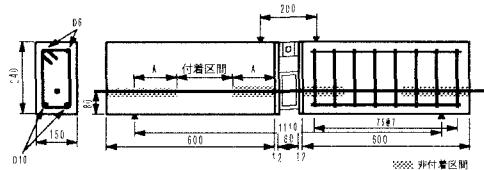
供試体の形状寸法および載荷条件 (単位:mm)
